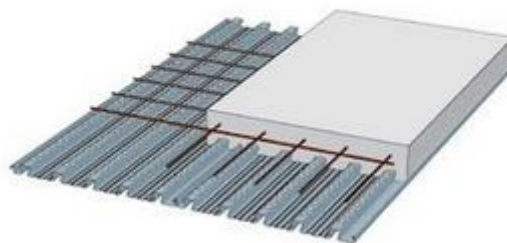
Losa de hormigón sobre chapa Cofrastra (<https://constructalia.arcelormittal.com>)
